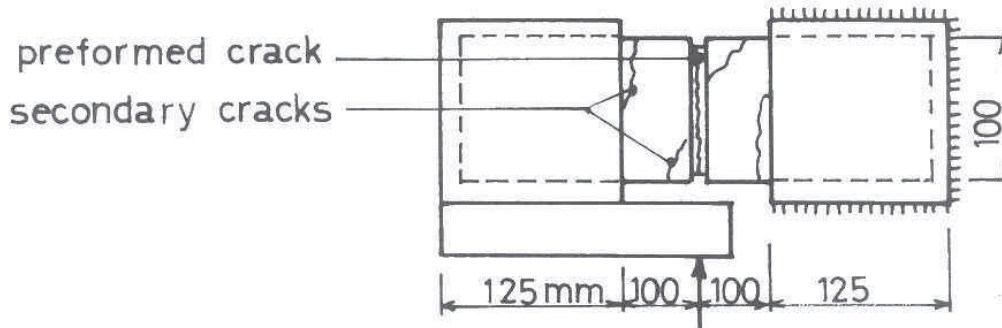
Dispositif et faciès de fissuration de l'essai de cisaillement de Fenwick et Paulay [1968].
